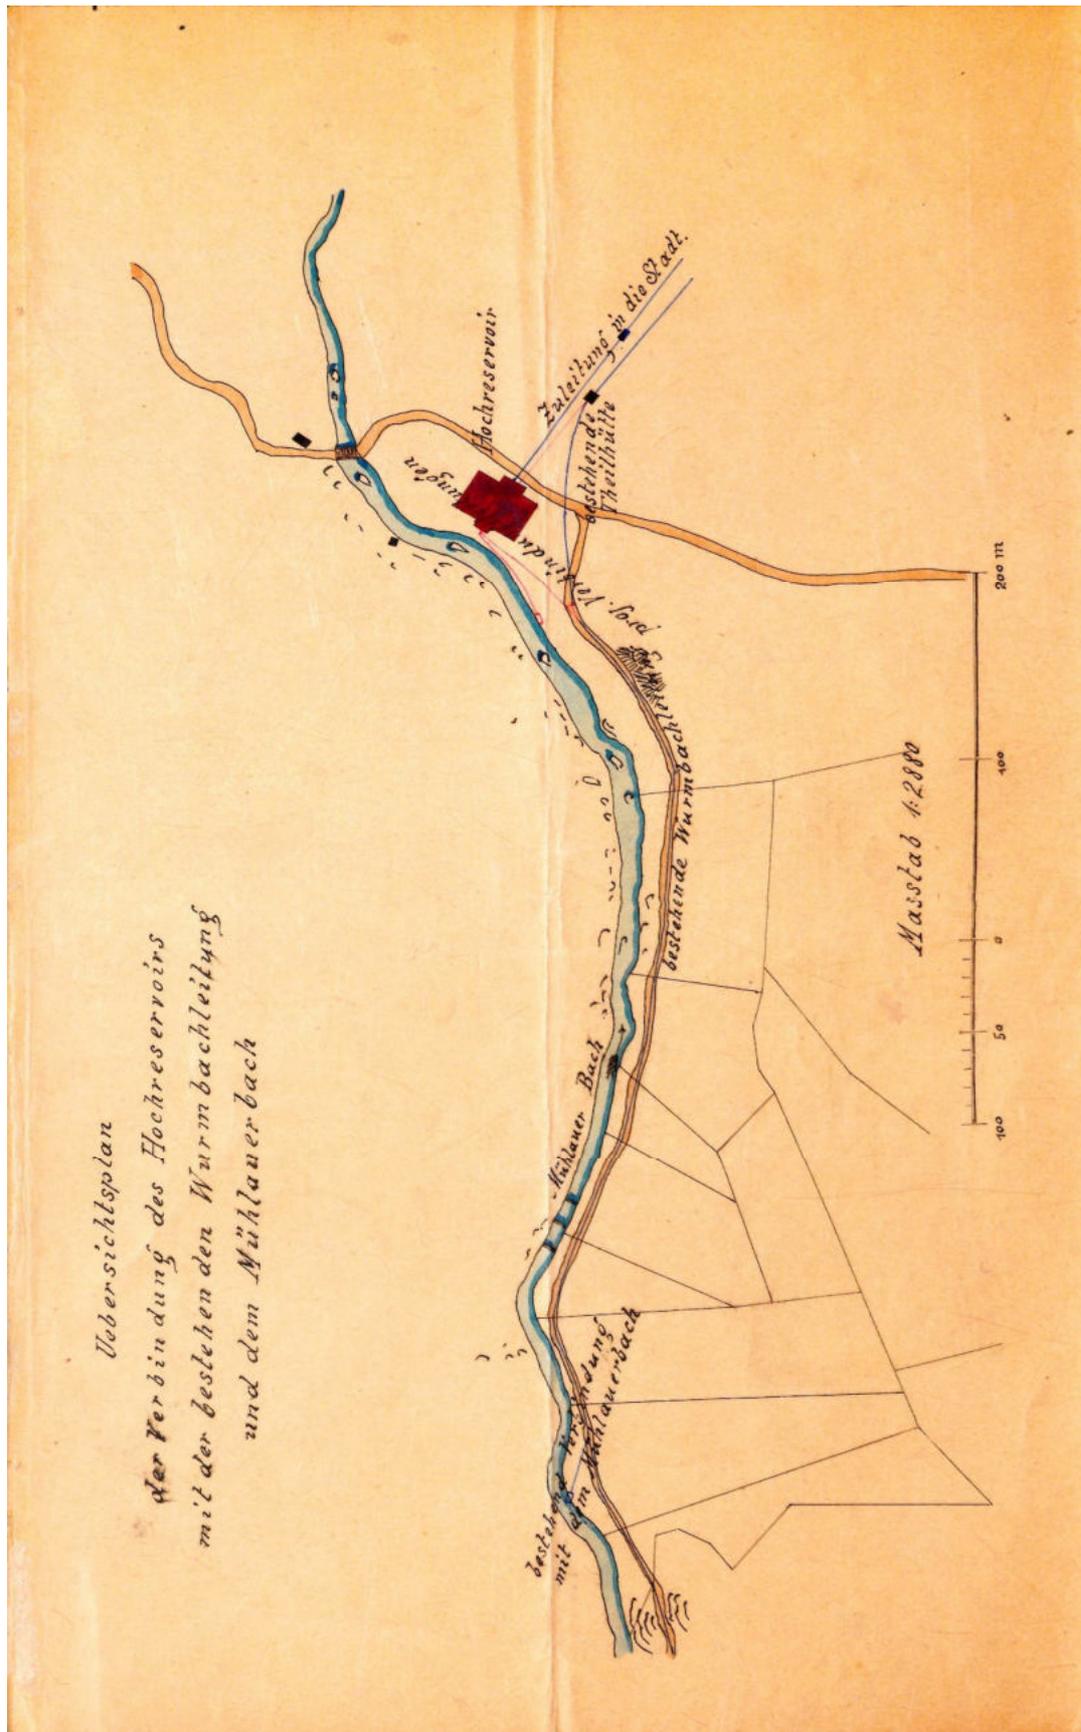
Lageplan des Wasserreservoirs der ersten Innsbrucker Hochdruck-Trinkwasserleitung. StAI, Plan 681.
